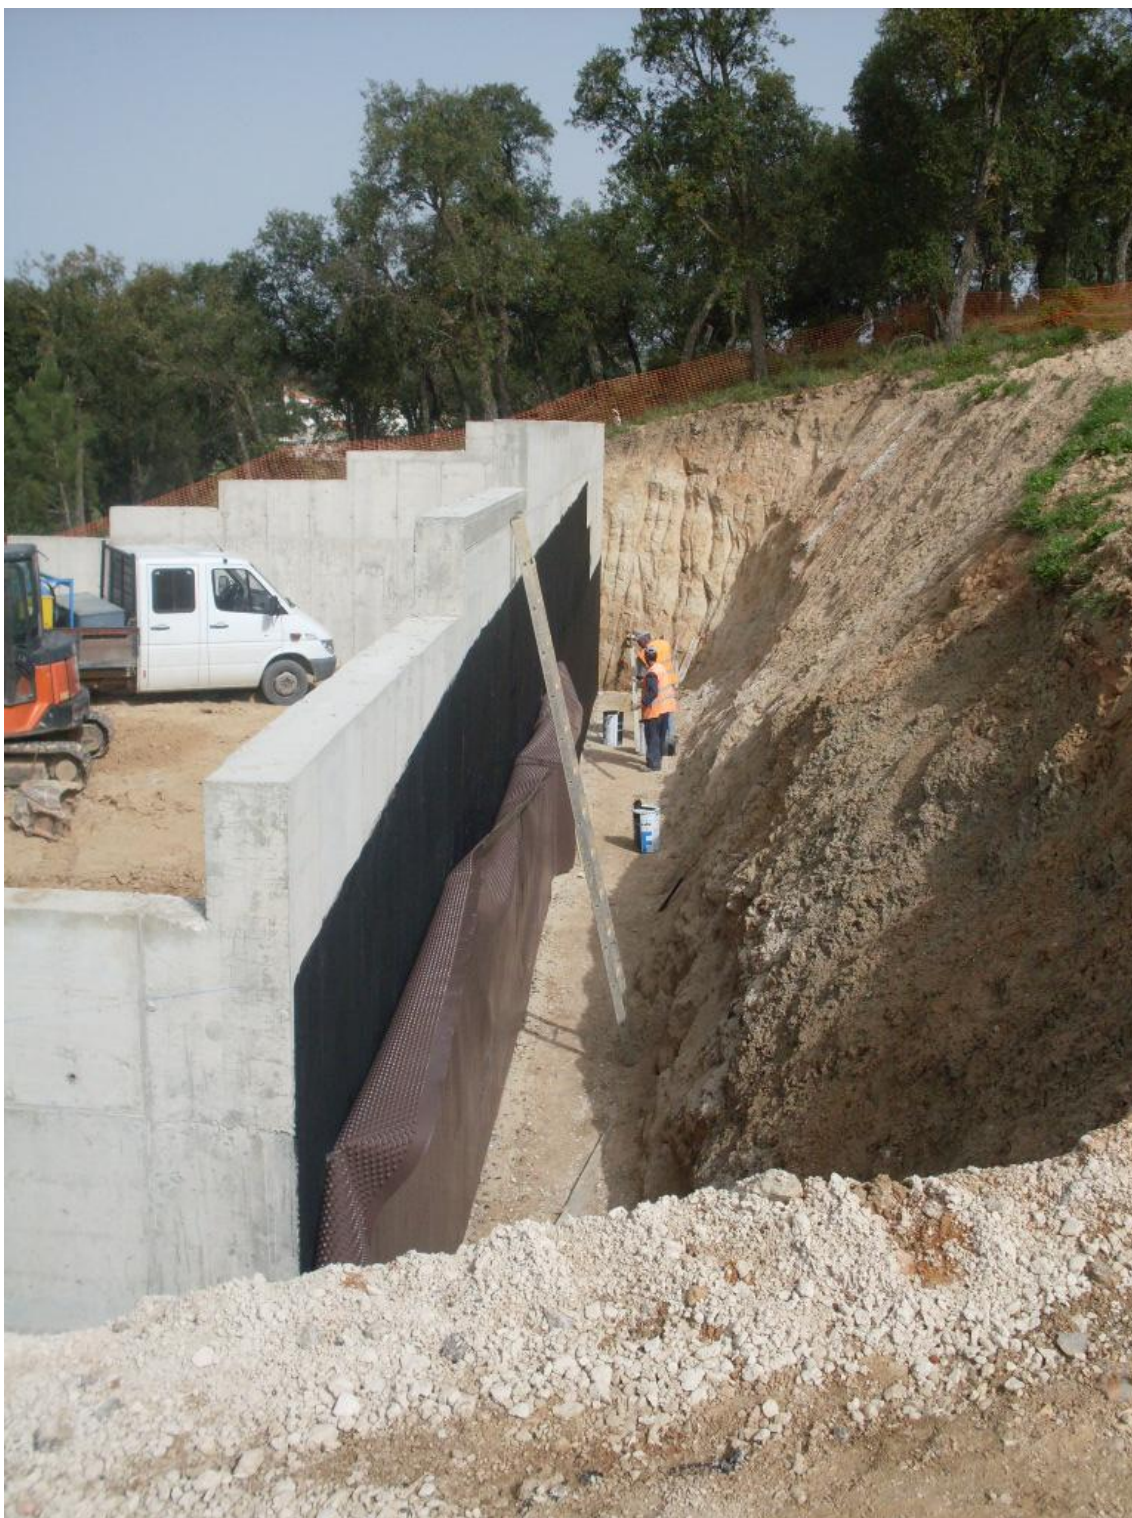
Colocação de tela impermeável – Arquivo Pessoal
